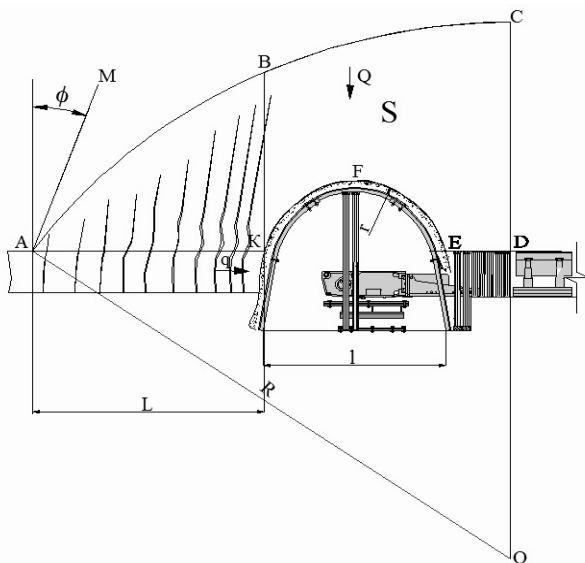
Схема к расчету нагрузки на крепь охраняемой выработки
